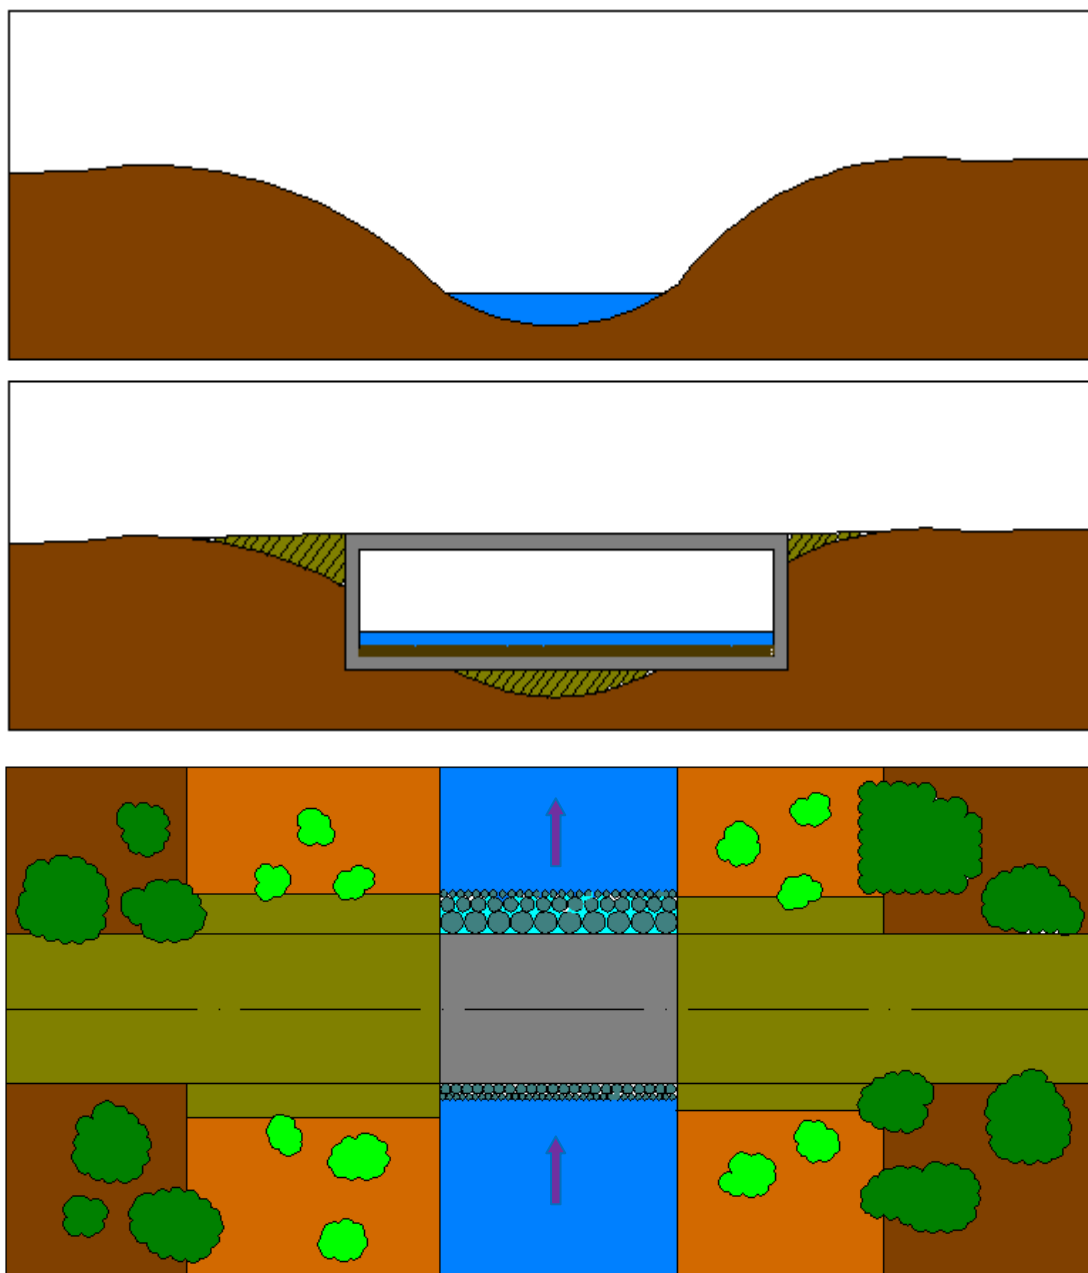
Ejemplo de la sección transversal y en planta de un marco prefabricado.
